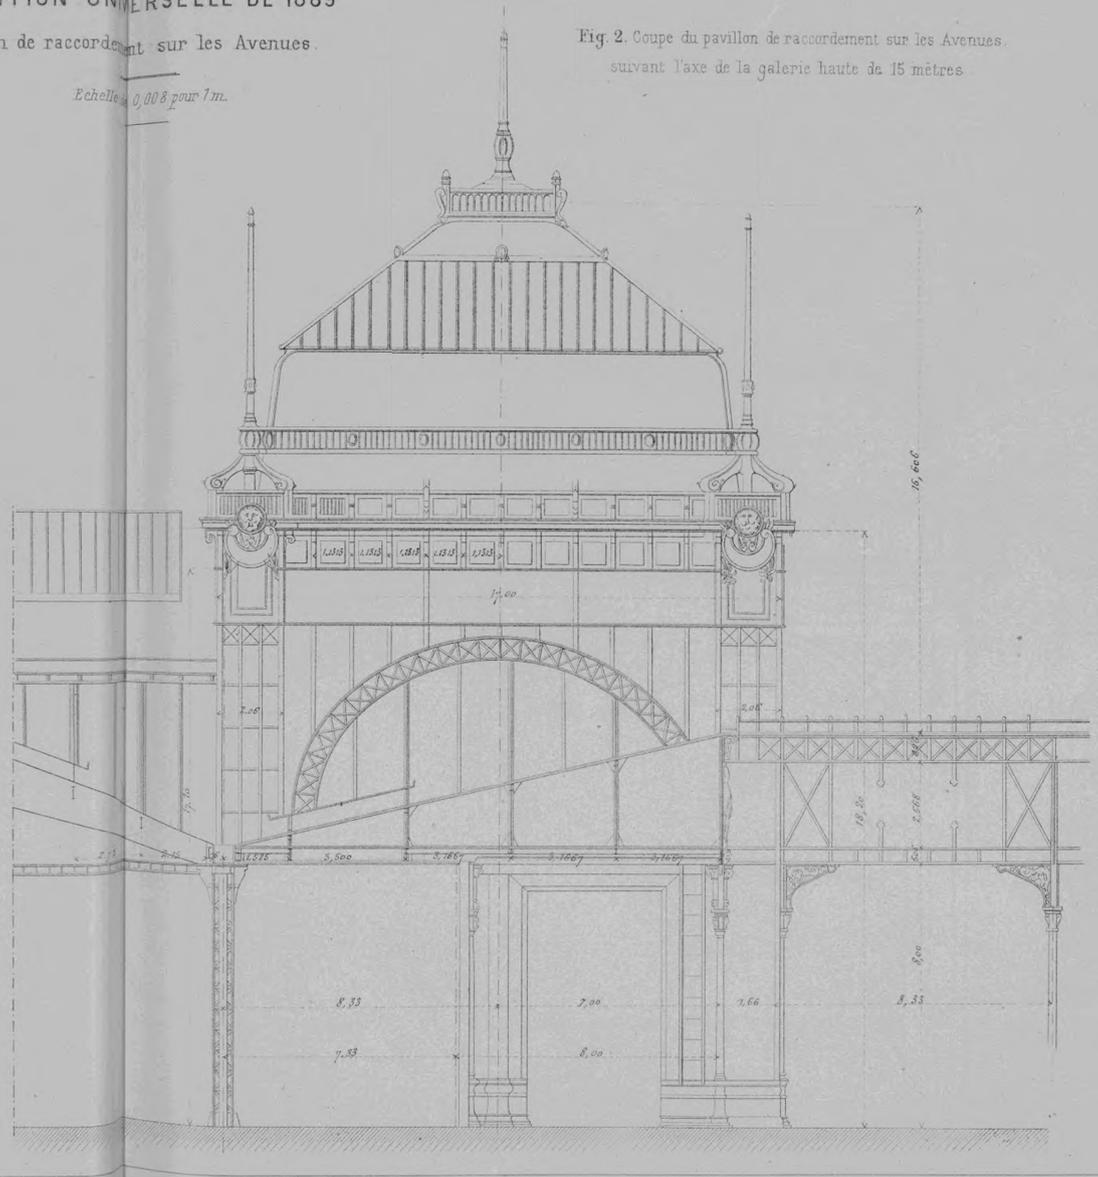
Coupe du pavillon de raccordement sur les Avenues. suivant l'axe de la galerie haute de 15 mètres.
